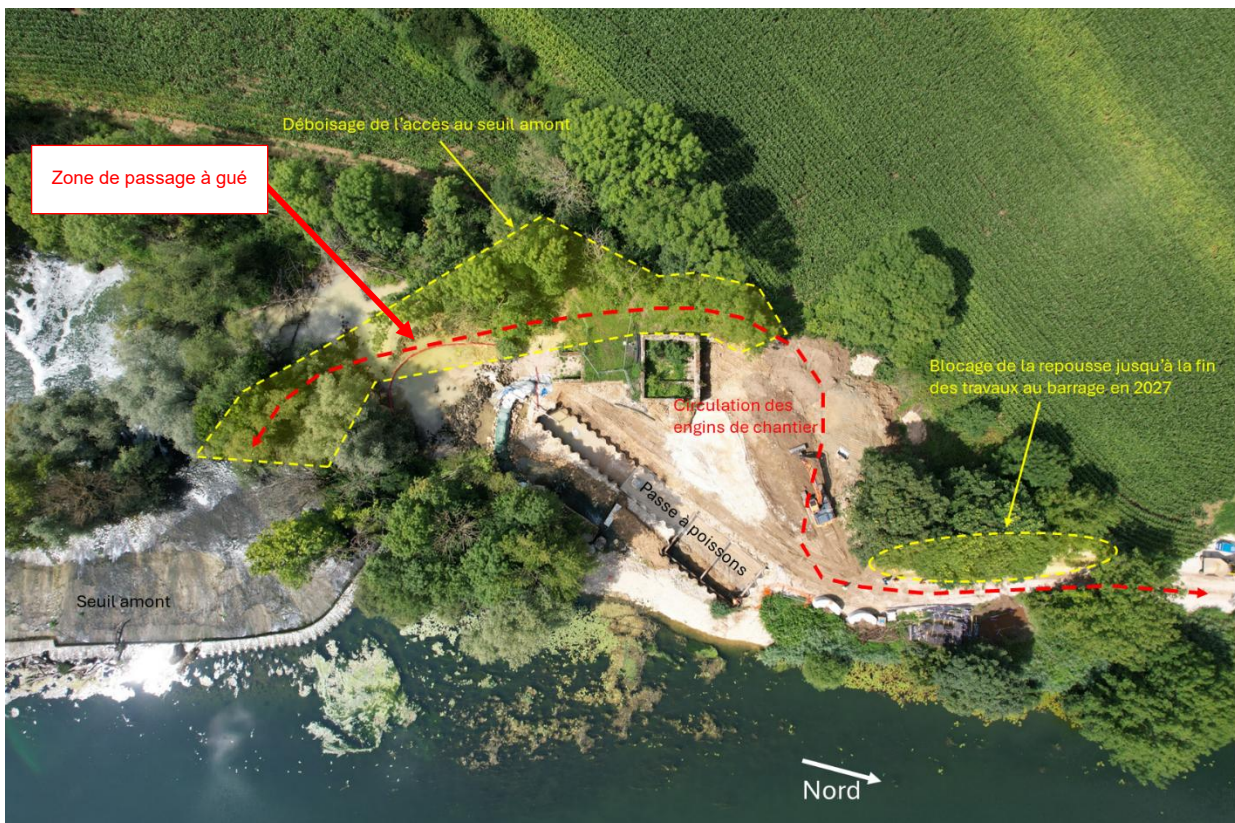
Zones possibles d'implantation de la traversée du lit pour l'accès par la rive droite
